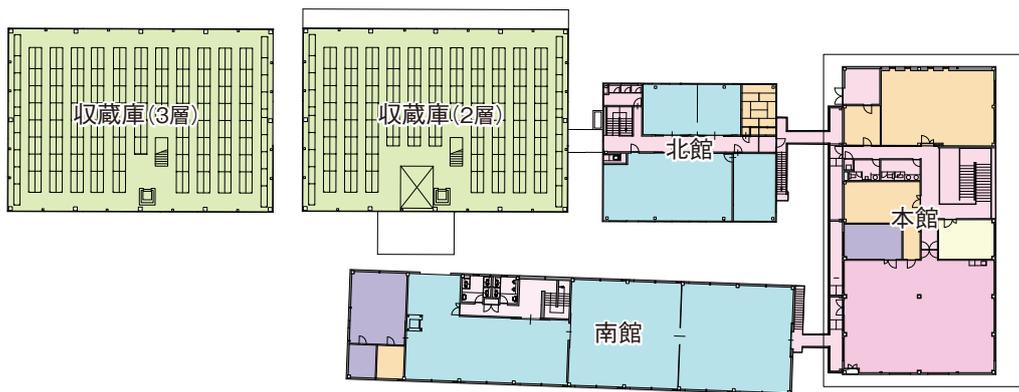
高知県立埋蔵文化財センター 2F 平面図(S=1/800)
